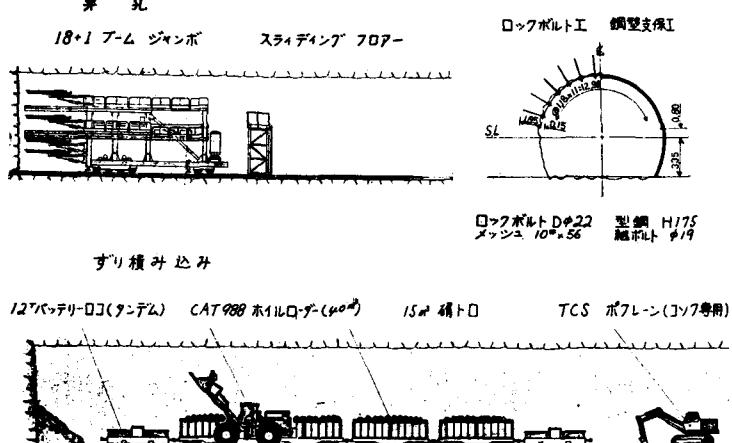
大清水ずい道・万太郎谷工区・全断面掘さくの施工
